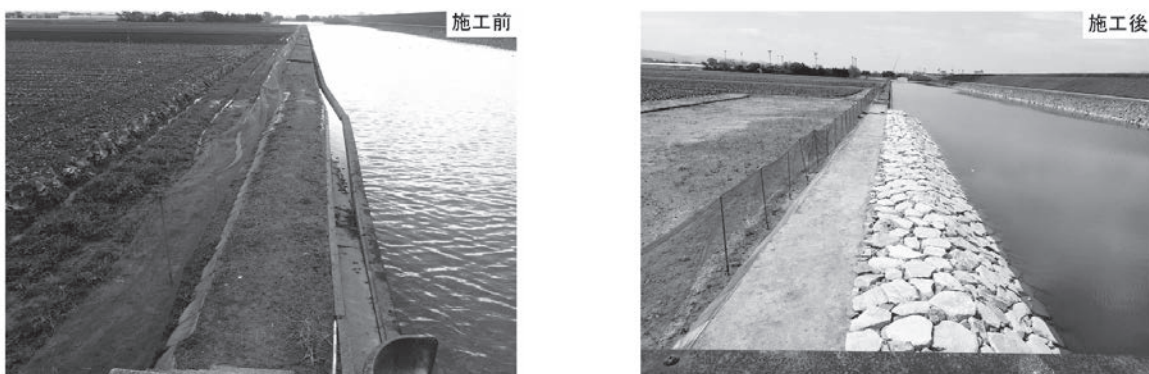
潮遊池護岸復旧 施工前施工後写真（郡築海岸）
